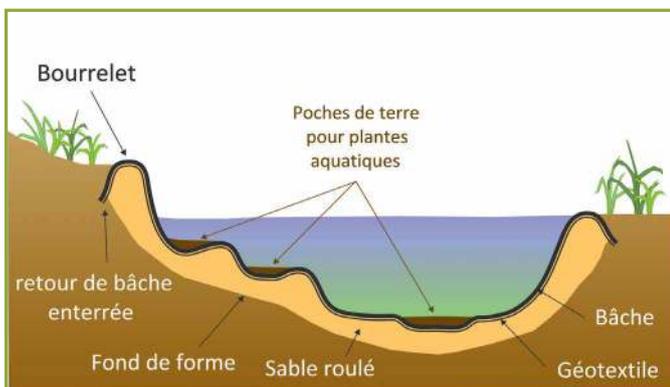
Schéma en coupe de l'installation d'une bâche d'étanchéité (Dessin de C. Houel)
